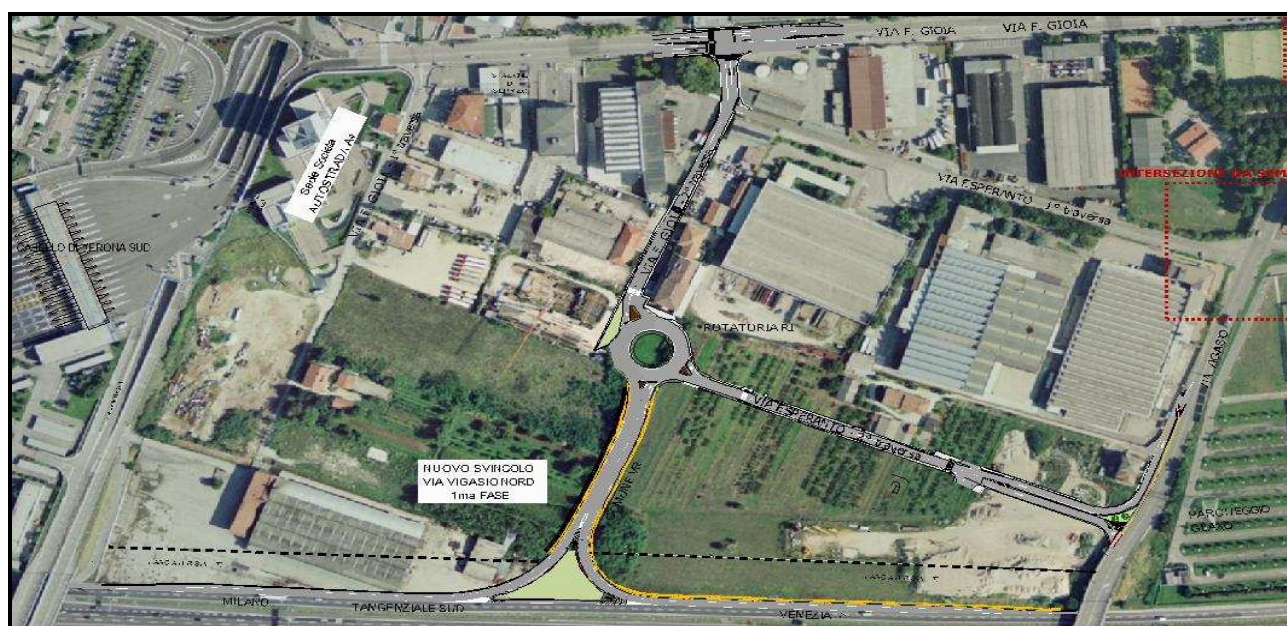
Svincolo di via Vigasio – Planimetria dell'intervento lato NORD
